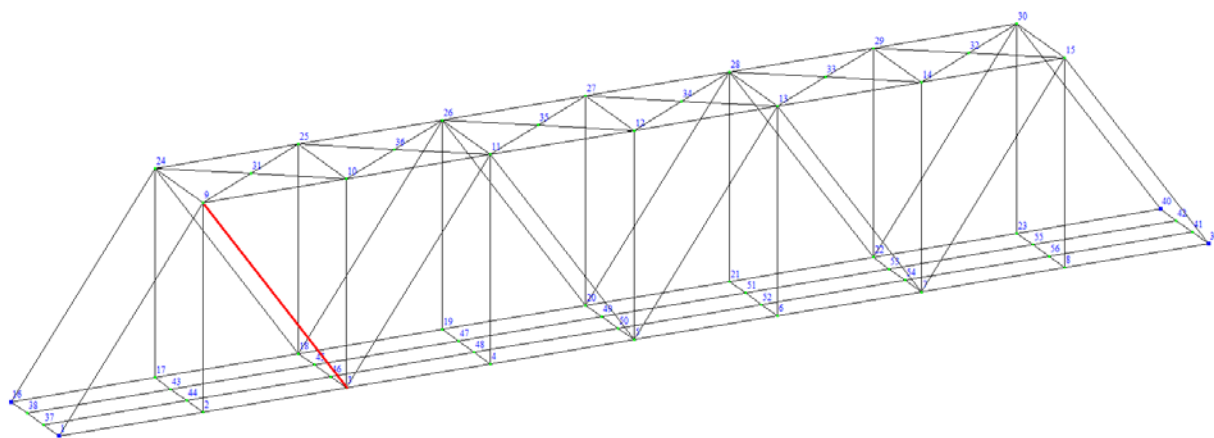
Расчетная схема фермы железнодорожного моста с нумерацией узлов
